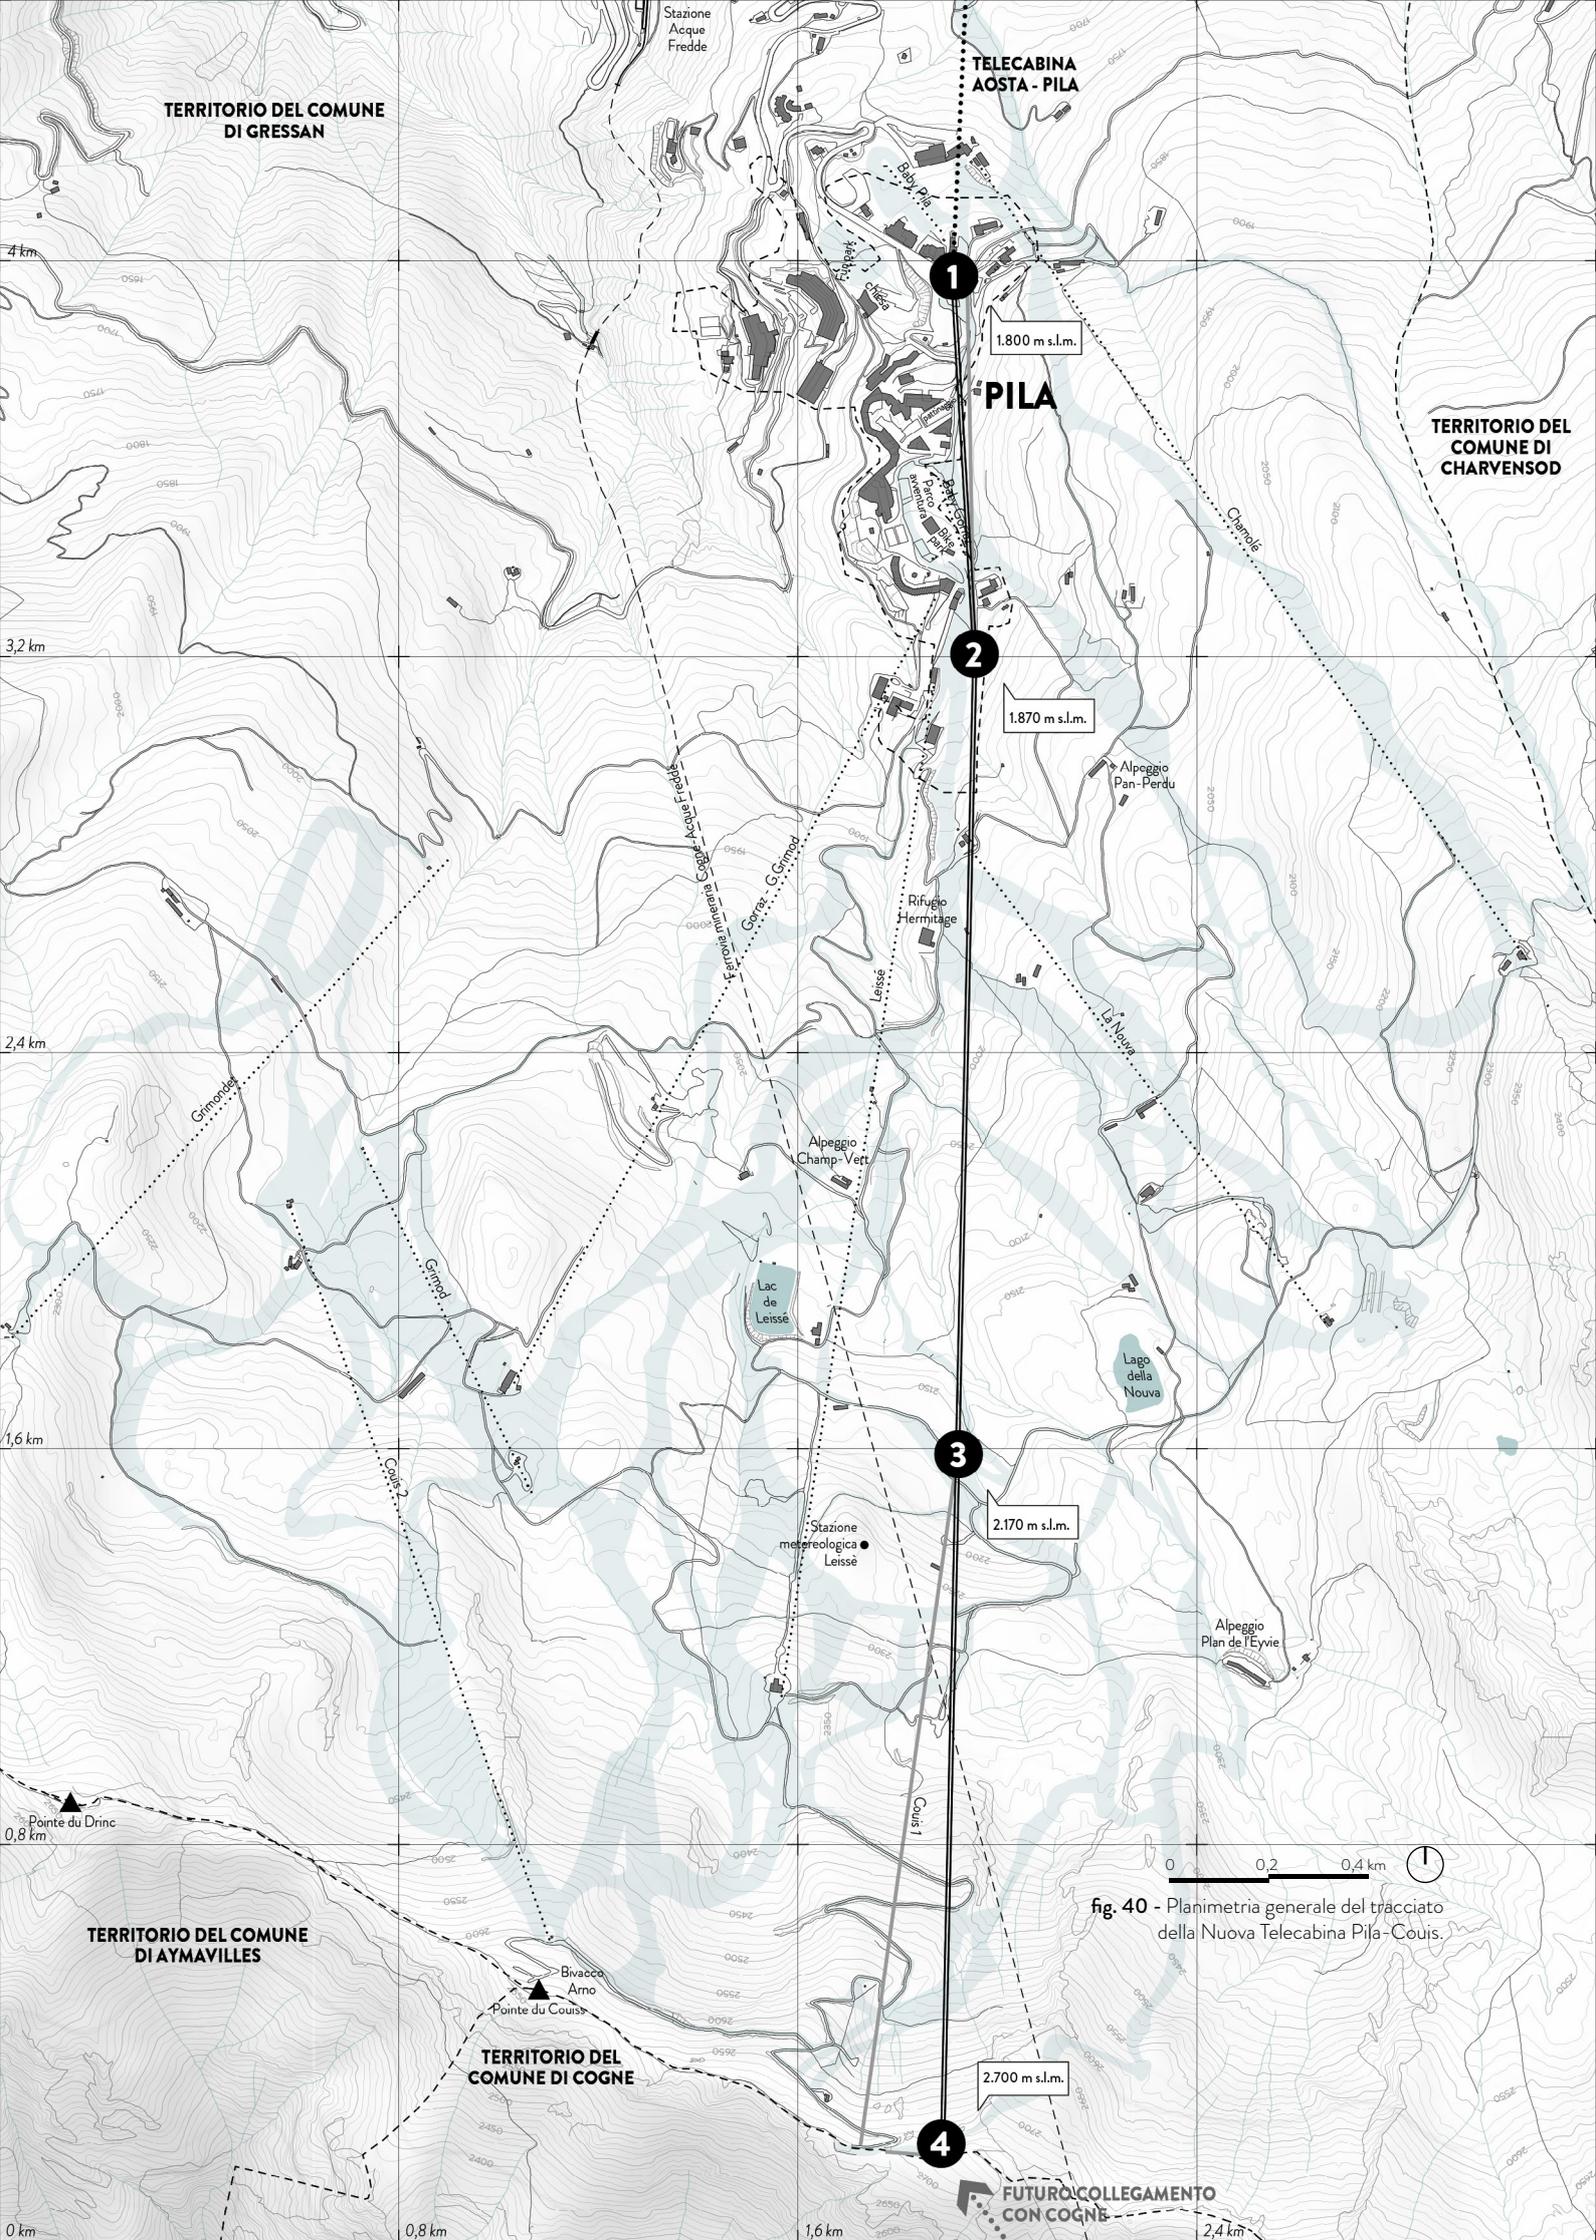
Planimetria generale del tracciato della Nuova Telecabina Pila-Couais.
